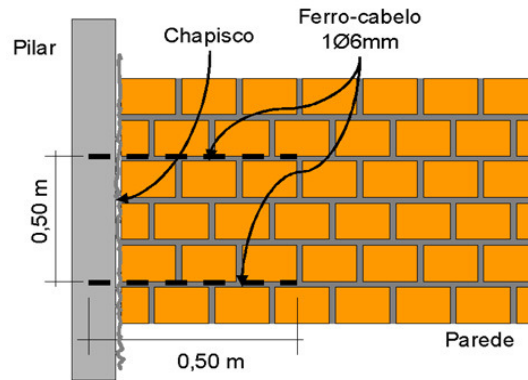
Forma da correta ancoragem entre a alvenaria e pilar
